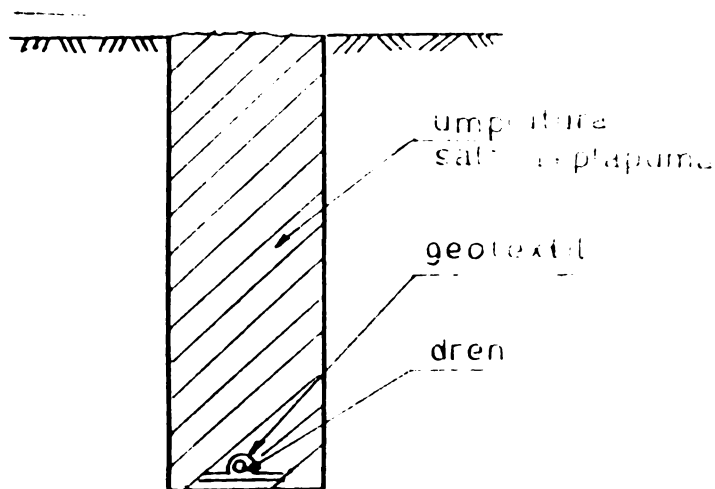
Secțiune transversală prin șanțul de drenaj având ca material filtrant geotextil așezat ca saltea și plapumă.
